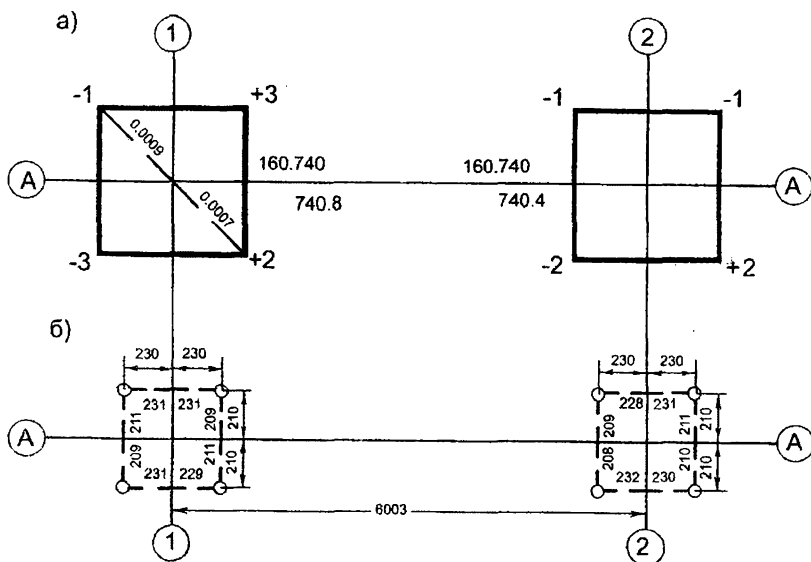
Исполнительная схема фундаментов под металлические колонны: а – верхней плоскости фундамента; б – установки анкерных болтов
